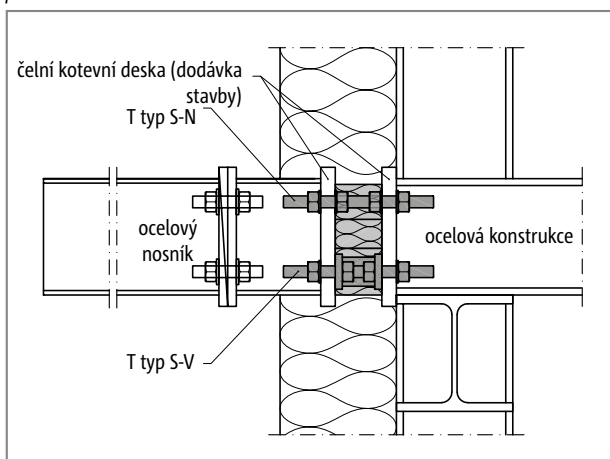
Schöck Isokorb® T typ S-V: Podepřená ocelová konstrukce
